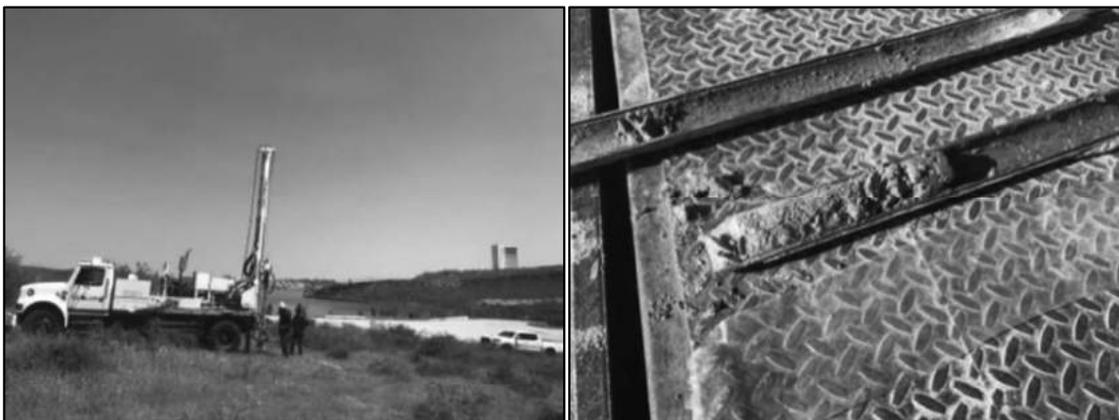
Muestras del subsuelo. Fuente: Mecánica de Suelos GEOLAPA.
